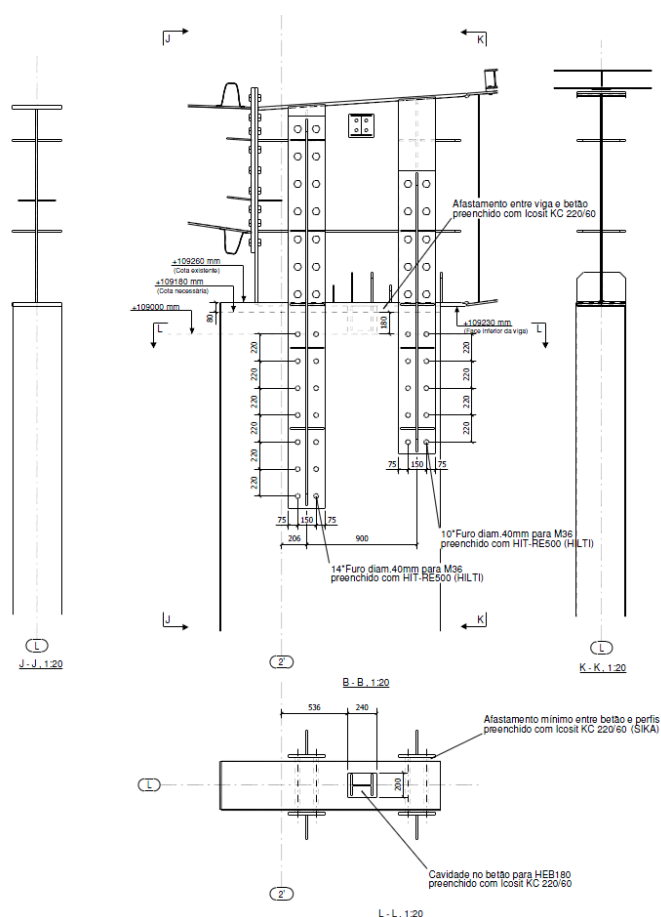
Pormenor de ligação asna-pilar de betão armado
